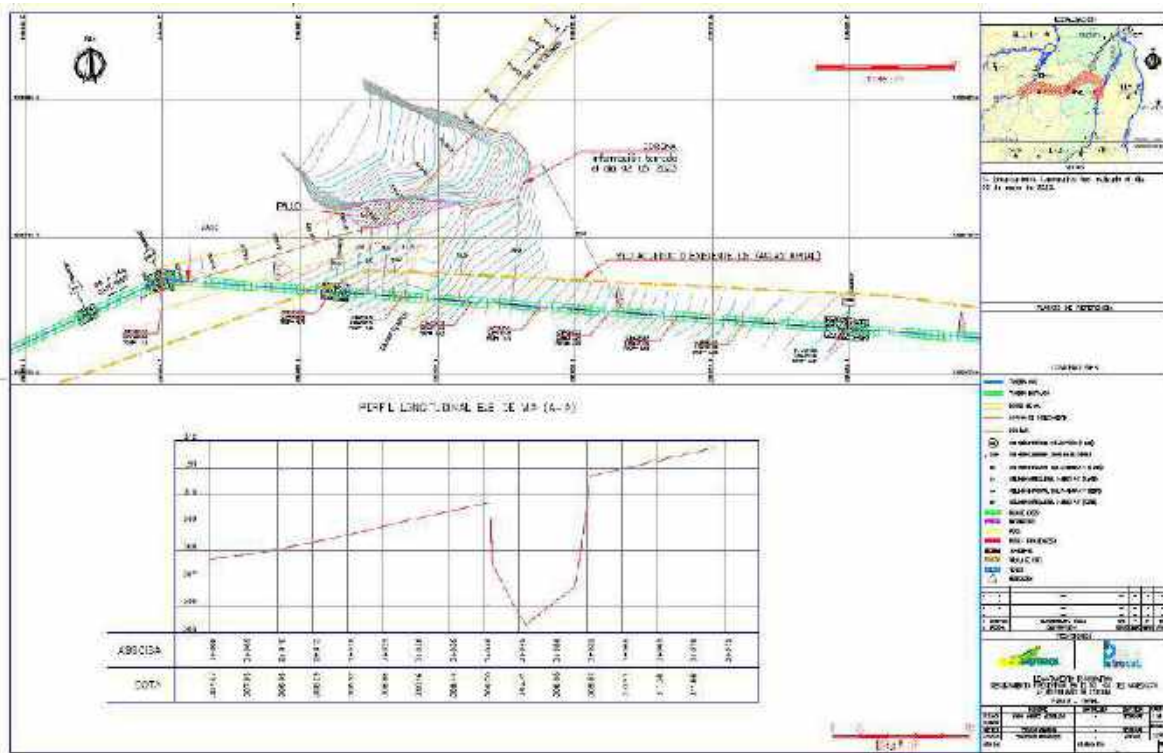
Imagen Plano levantamiento topográfico de la zona del deslizamiento.
